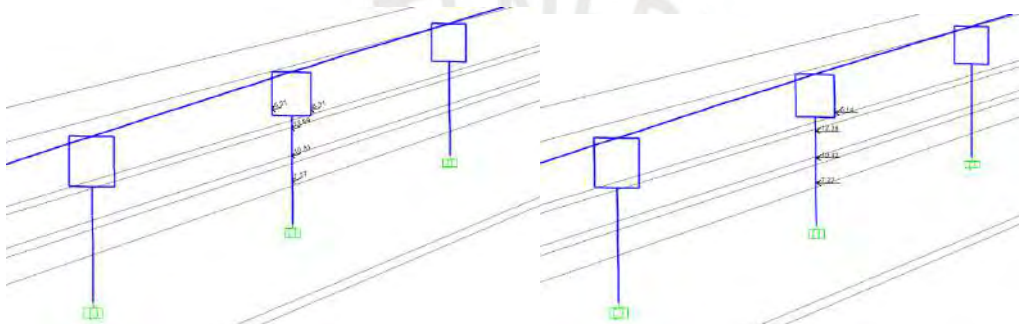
Viento Longitudinal y Transversal sobre una Pila
